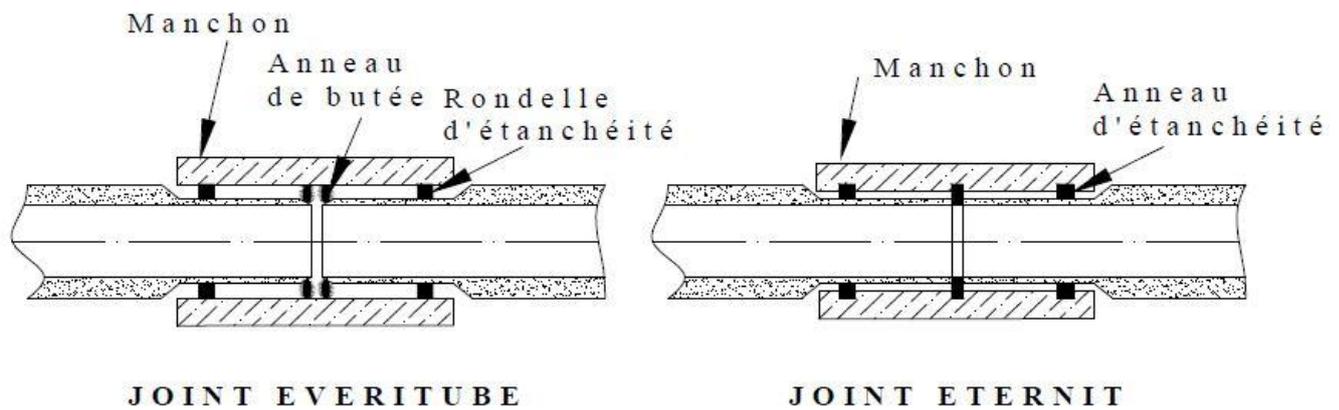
Joints sur tuyaux en amiante ciment.
